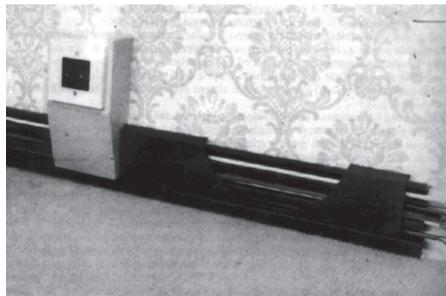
Zócalo en plástico tipo moldura para la colocación de cajas de conexiones.
